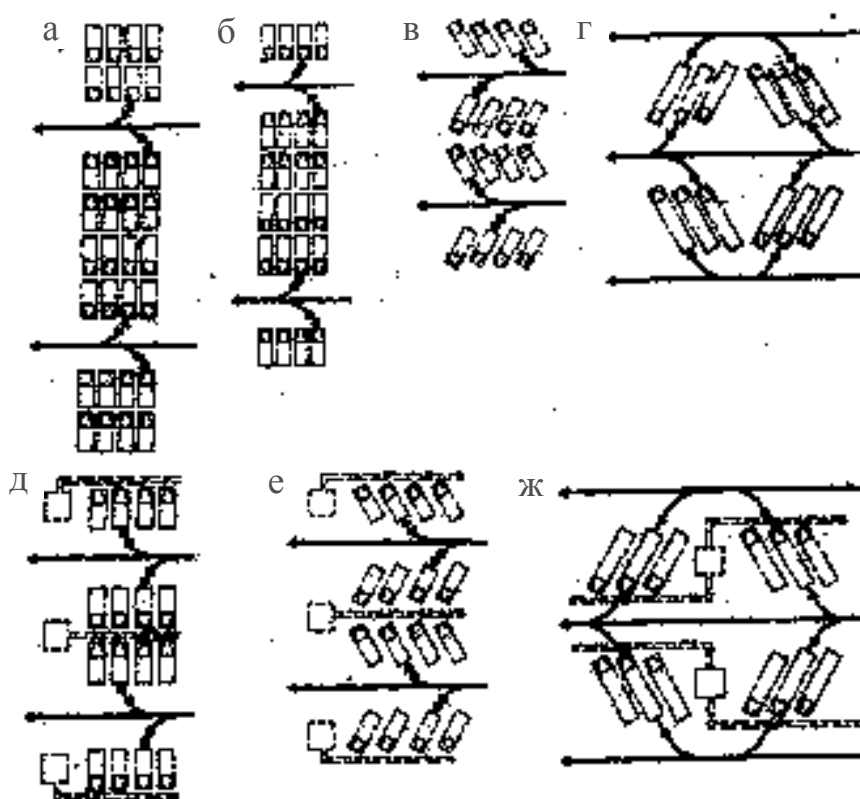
Схема расстановки подвижного состава на открытых площадках хранения
